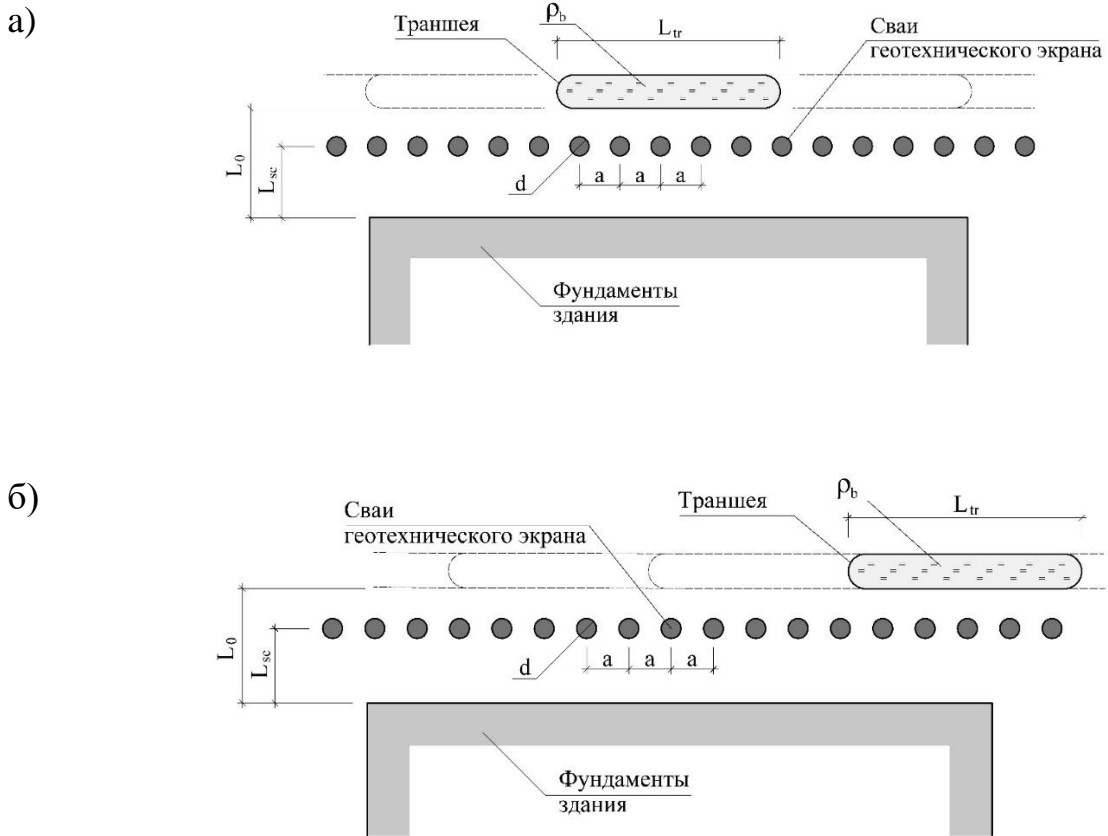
Схема расположения траншеи относительно фундамента здания:
